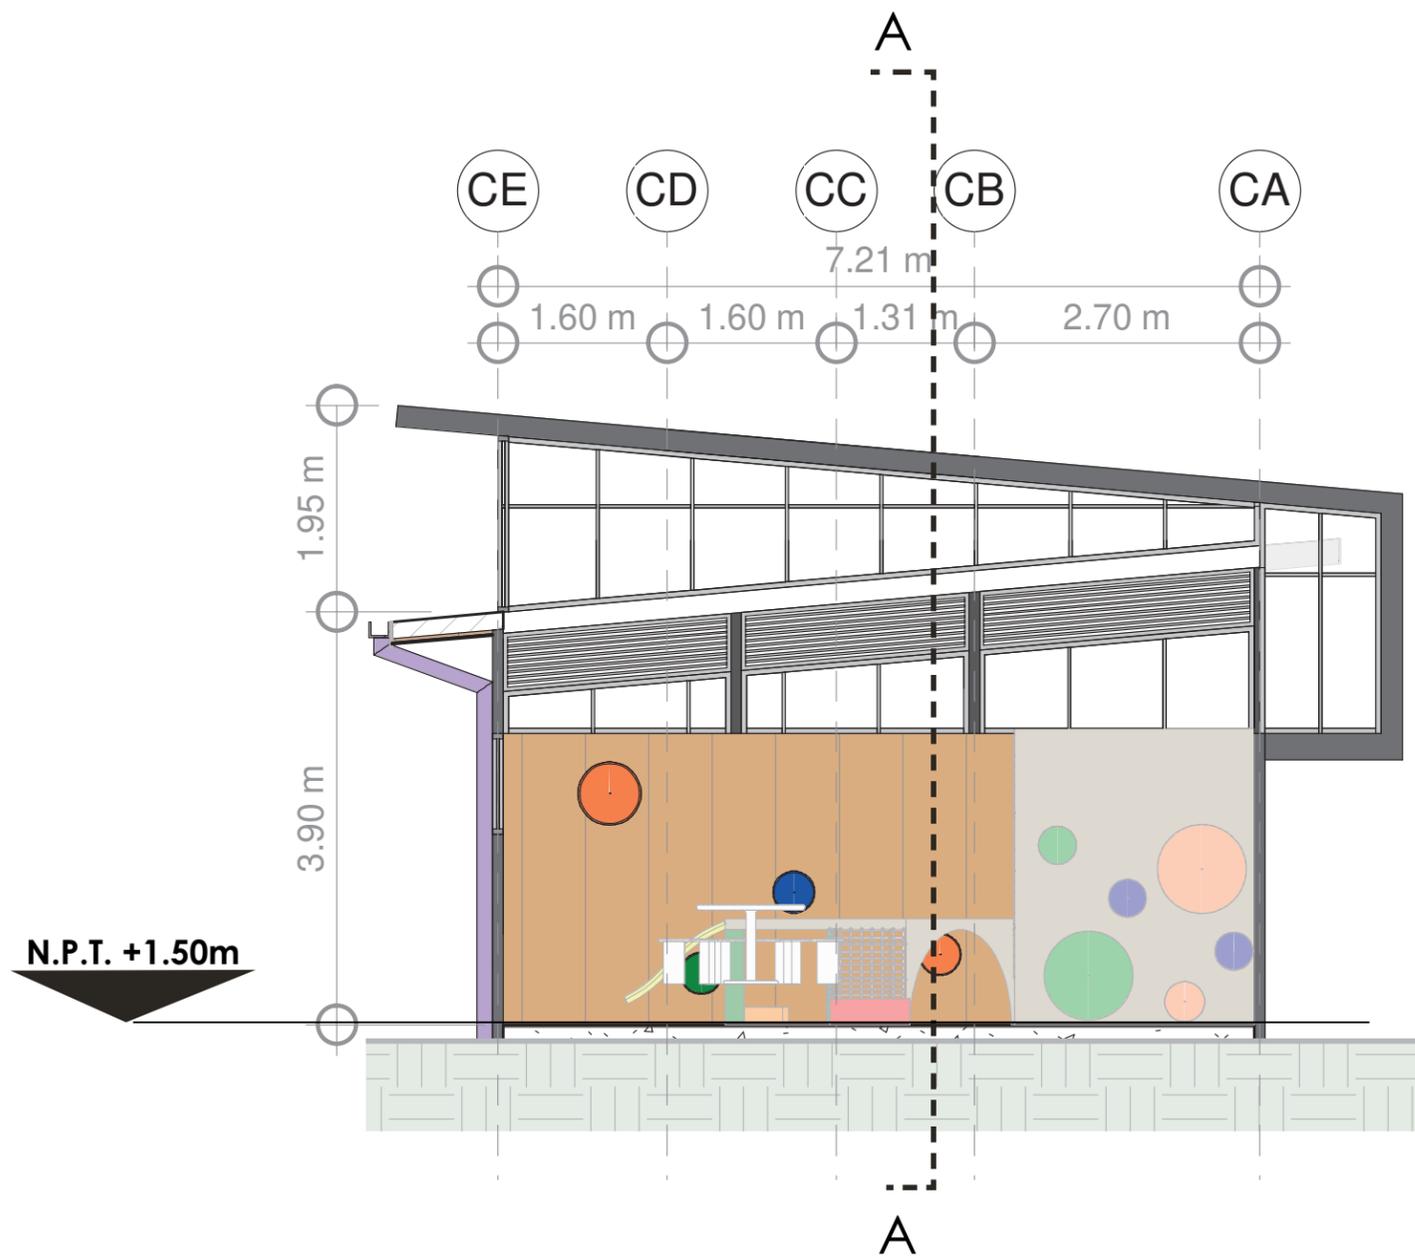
Sección B-B de bloque de cuidado. Fuente: Propia.
